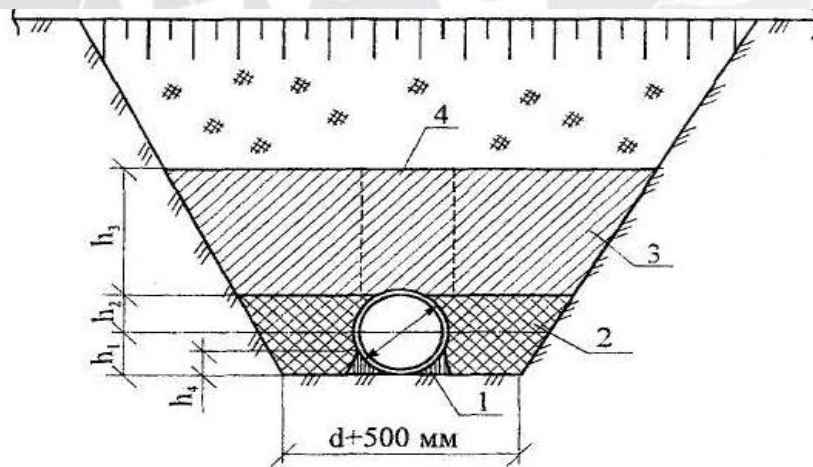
Схема уплотнения грунта вокруг трубопровода из ПВХ при засыпке траншей
